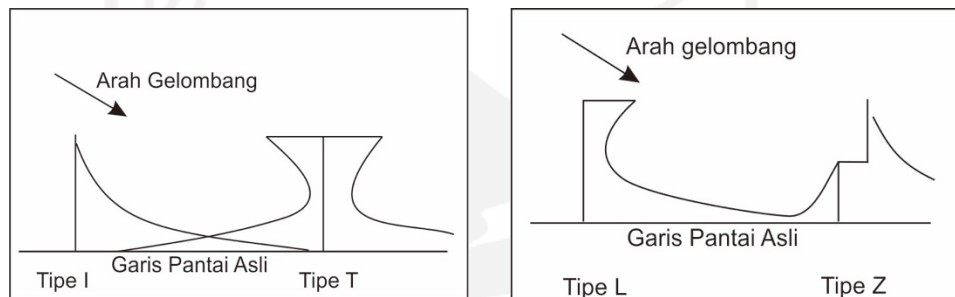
Desain alternatif struktur bangunan jetty untuk perbaikan sungai Tipar
